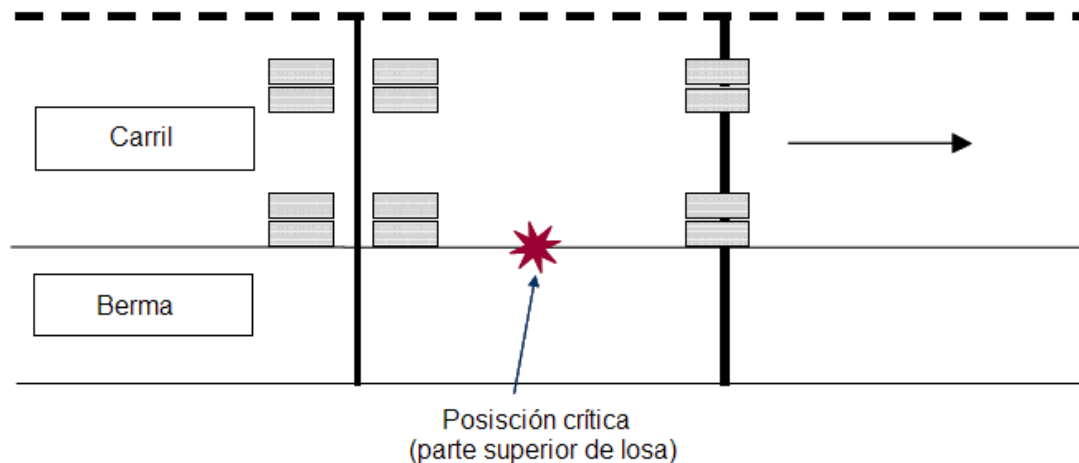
Posición y carga crítica para las fisuras transversales arriba – abajo
